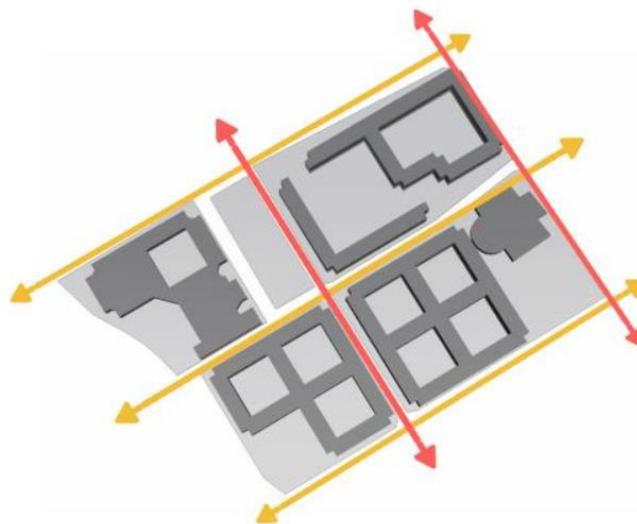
Circulaciones en planta del Conjunto Nueva Santa Fe
